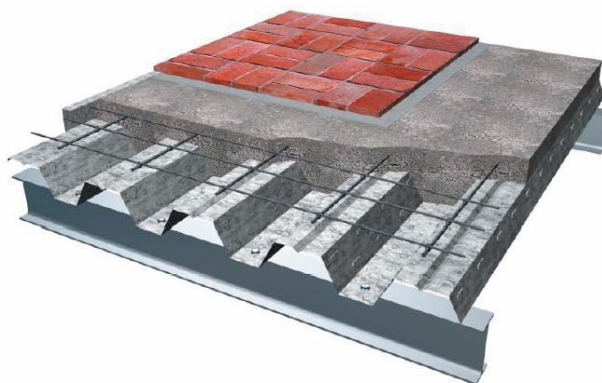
Vista de forjado mixto de chapa colaborante.
